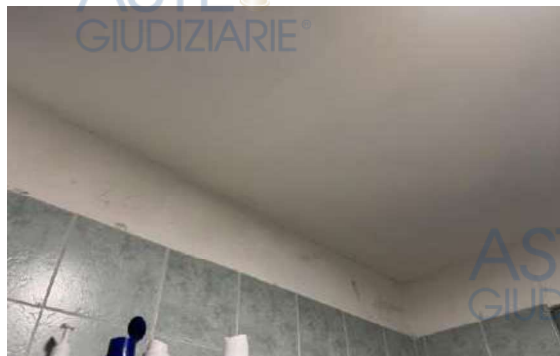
Presenza di infiltrazioni e condensa nella parete del WC bagno
